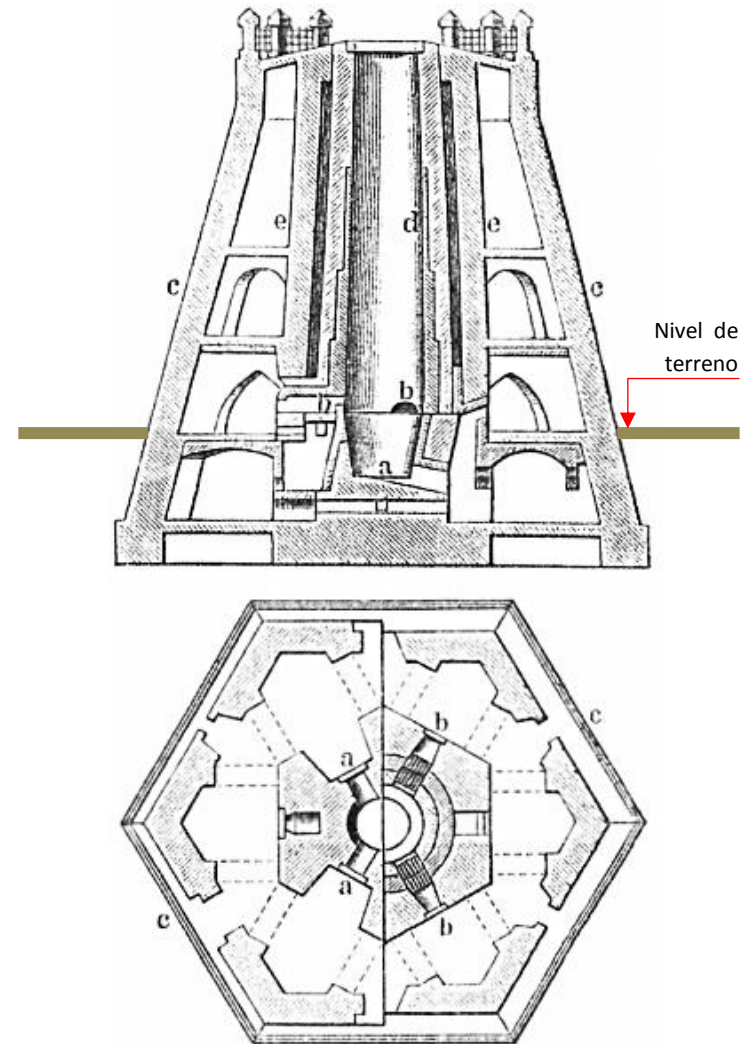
Plano de sección y planta del horno Rumford. La planta se divide en dos secciones, la de la izquierda muestra el nivel inferior con las cajas de cenizas y las bocas de extracción de cal, el lado derecho se encuentra a nivel del terreno y muestra el nivel de la parrilla y bocas de alimentación. Tomado de http://www.unbekannter-bergbau.de/inhalte/spot_12_2016_miltzgroitzsch.htm#verarbeitung
